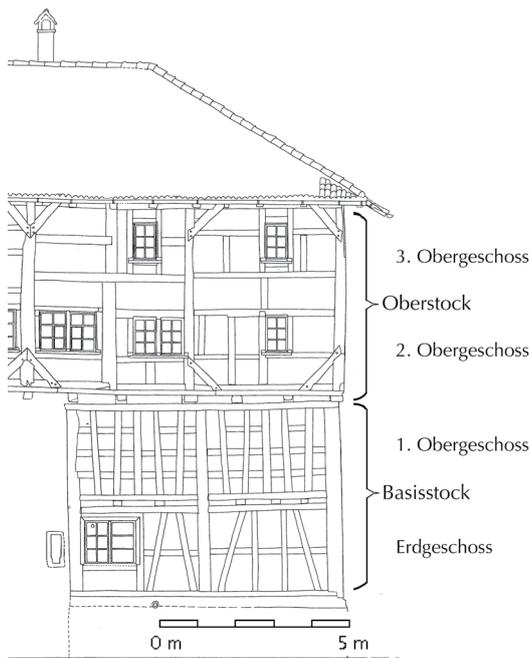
Zweistöckiges Traufgerüst mit jeweils zwei Geschossen. Amriswil, Schloss Hagenwil (Kt. Thurgau), 1413 (d).
